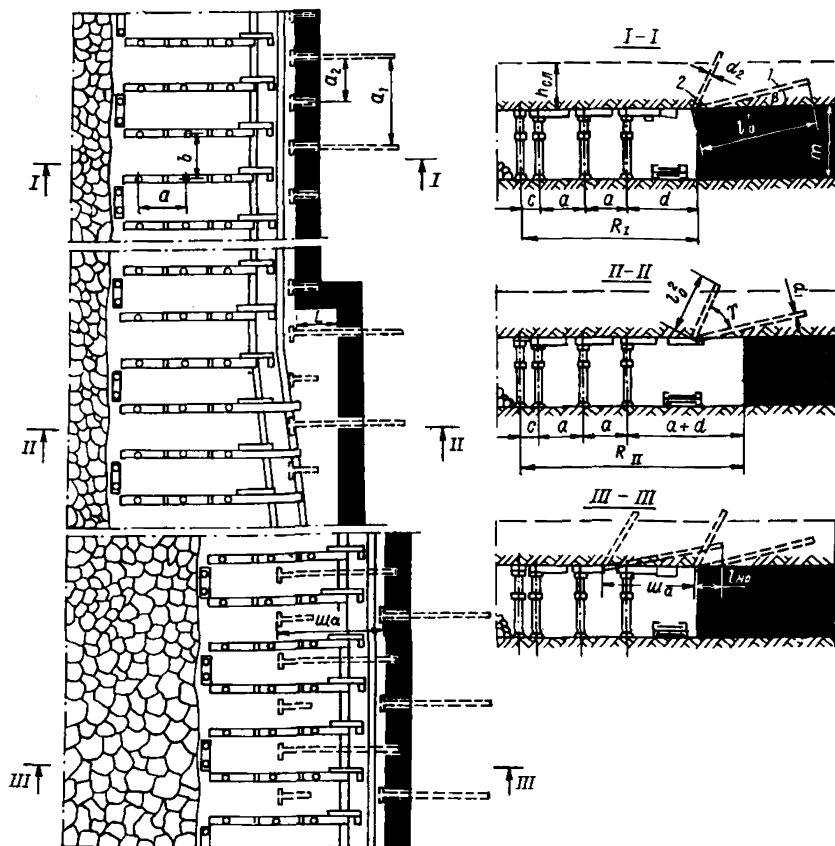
Схема крепления с удержанием неустойчивой кровли анкерной крепью (в том числе с упрочнением химическими смолами) в лавах с механизированной и индивидуальной крепью
